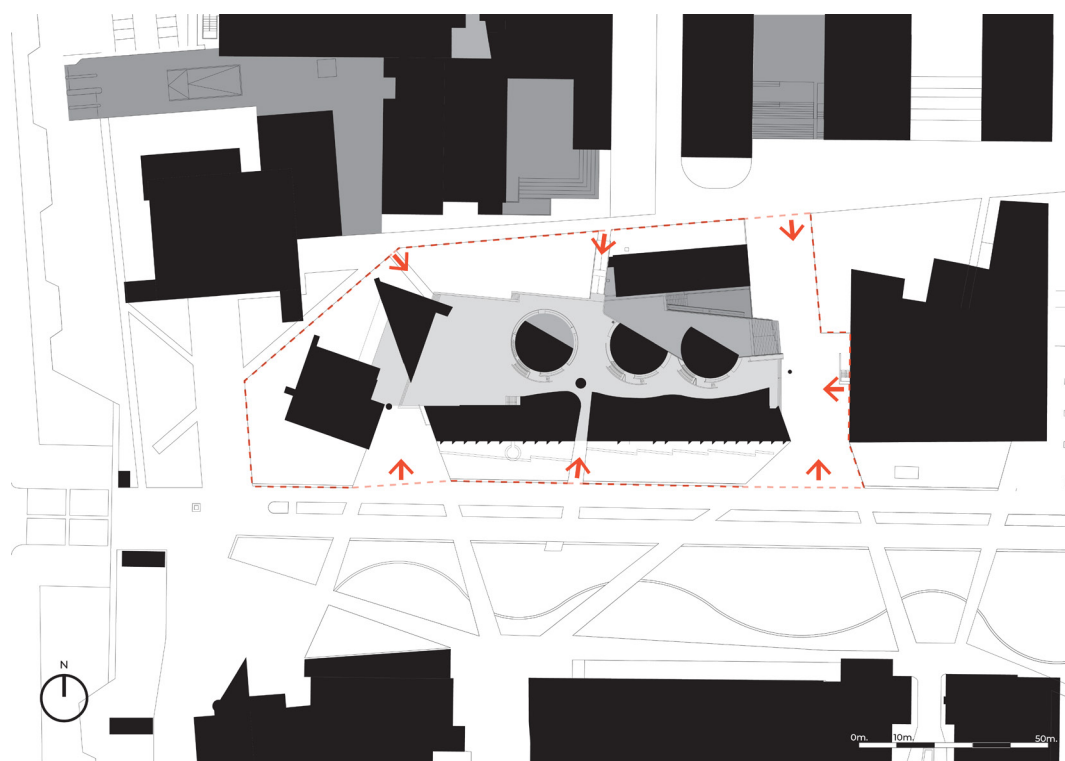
Plan Maestro Zonas Libres, Campus San Joaquín.
